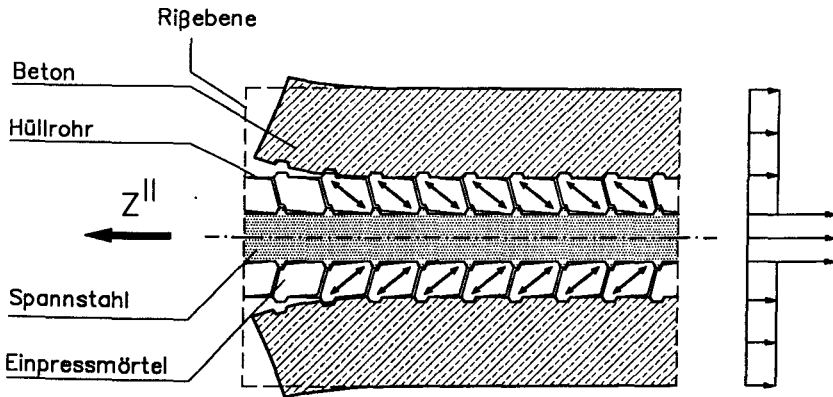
Übertragung der Verbundkräfte im System Spannstahl - Einpreßmörtel - Hüllrohr - Beton
